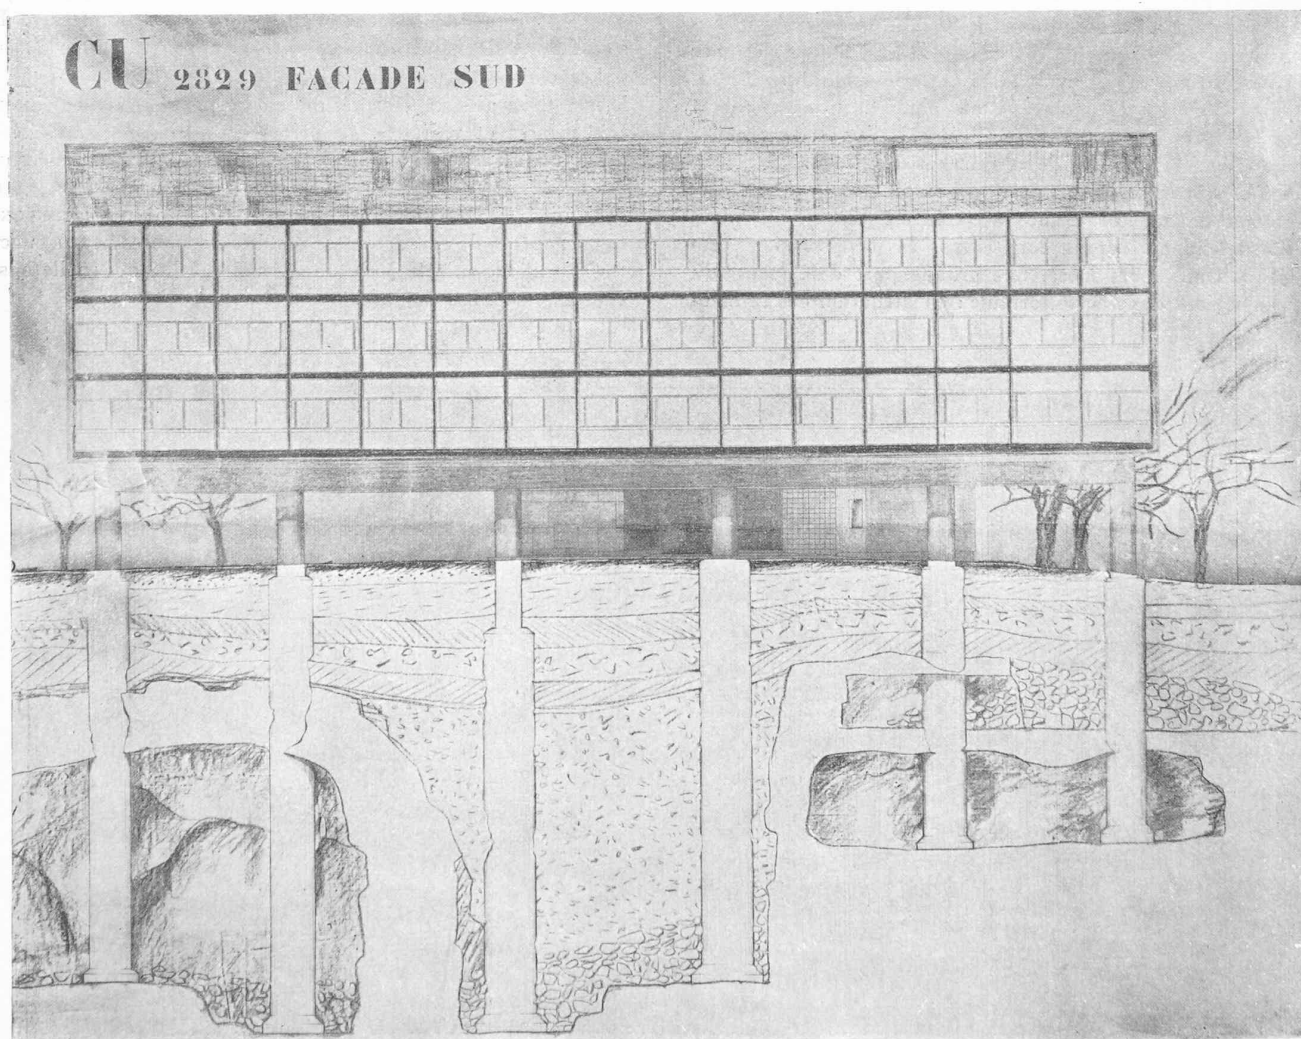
Fondations et façade du Pavillon suisse de la Cité universitaire de Paris.
